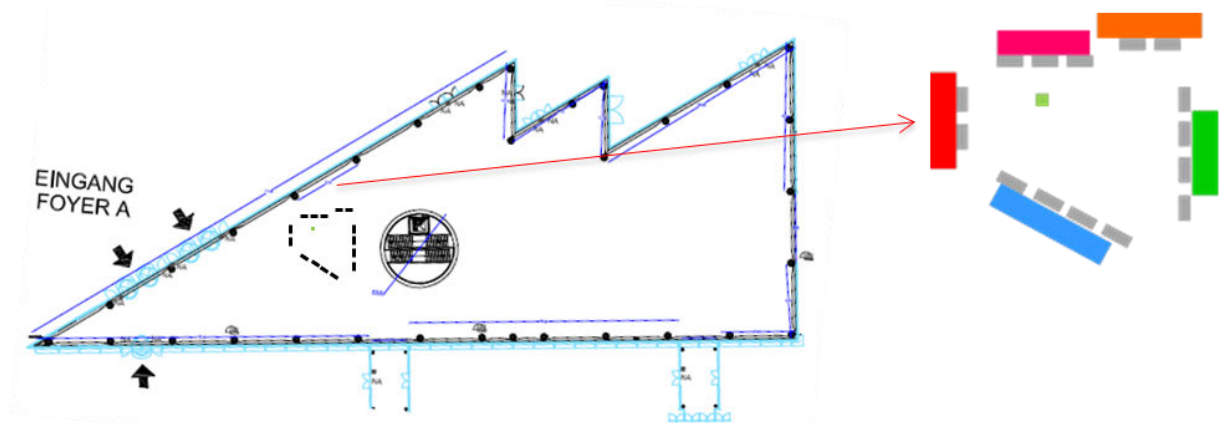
Grundriss Foyer A Messehalle Wien mit dem Setting des symbolischen Grätzels
